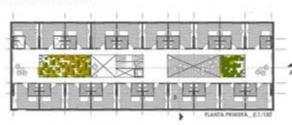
Planta primera - La Rioja Res. Univ. Fuente: Mundoarquitectura.com
